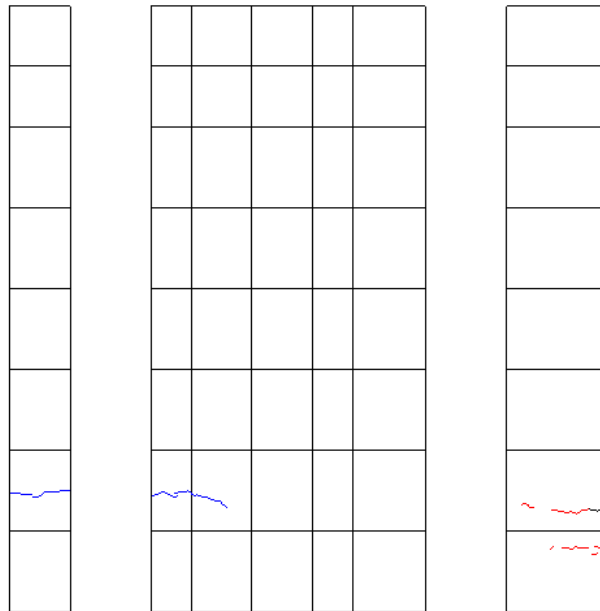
R=1/800 ひび割れ図
